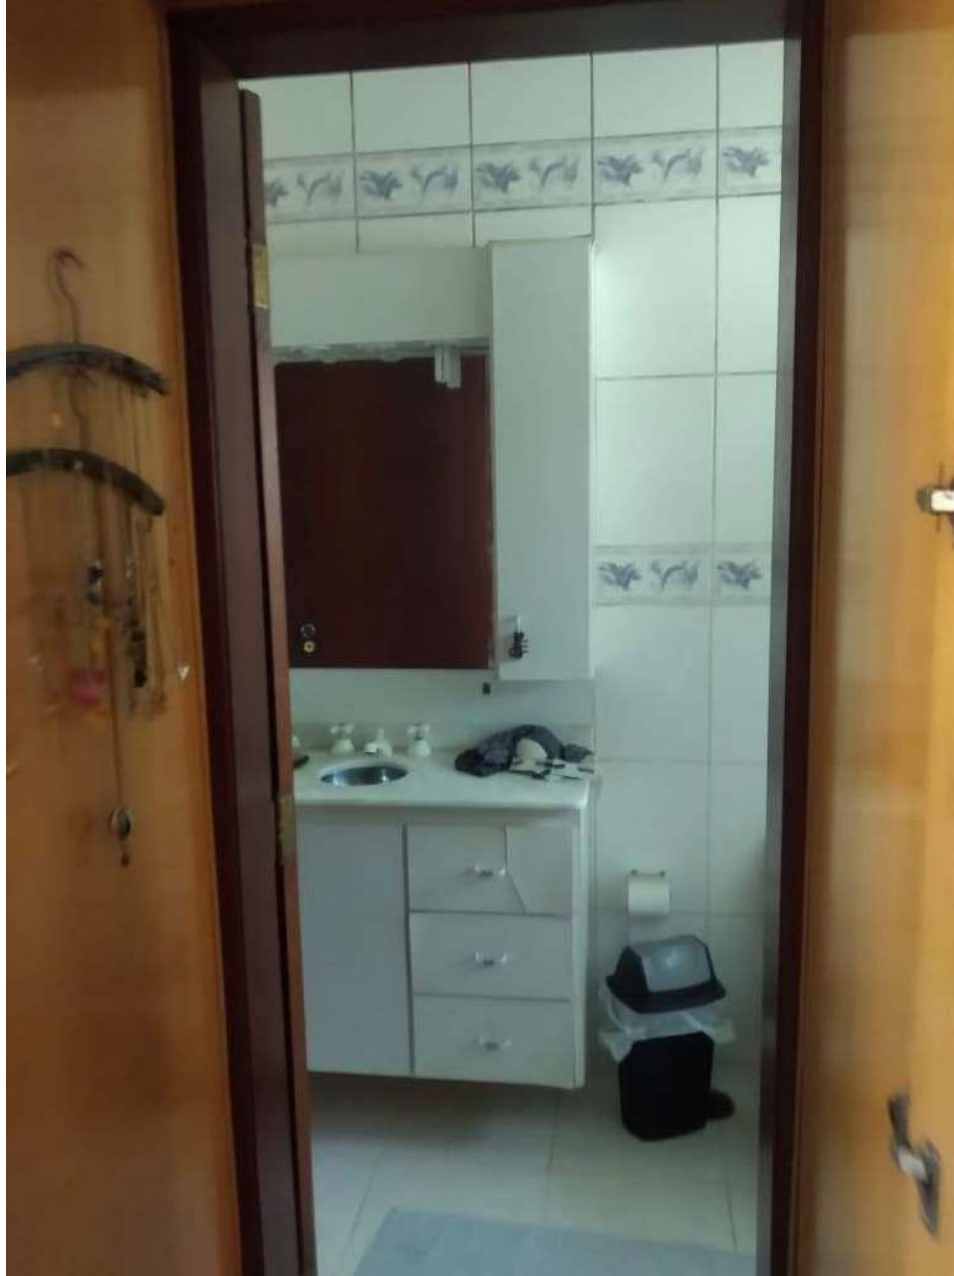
ACESSO AO BANHEIRO DA SUÍTE 4.
